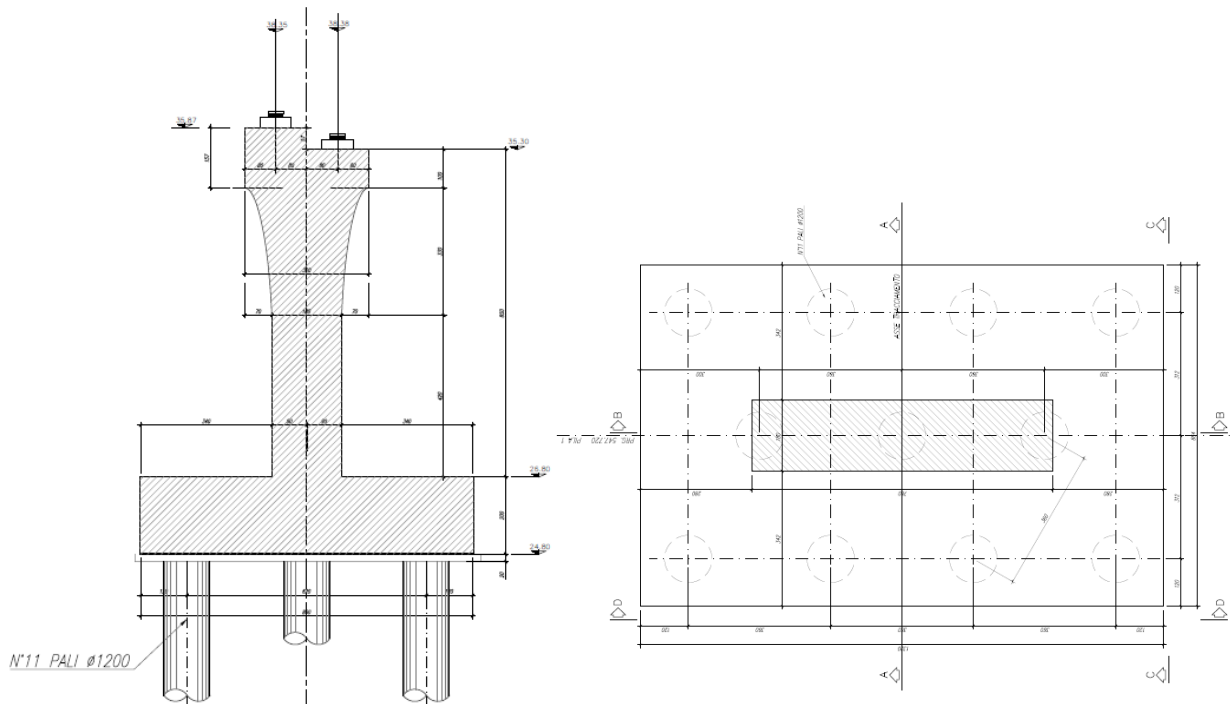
Sezione trasversale e Pianta delle fondazioni pile
